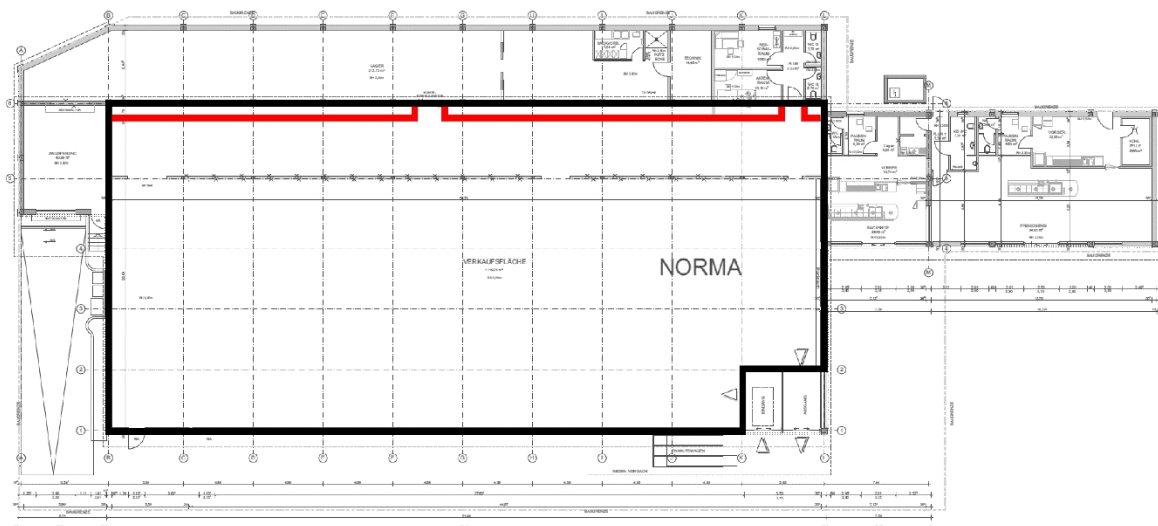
Grundriss des geplanten Umbaus (schwarz: Verkaufsraum, rot: Verkleinerung des Verkaufsraumes durch Trockenbauwand)
